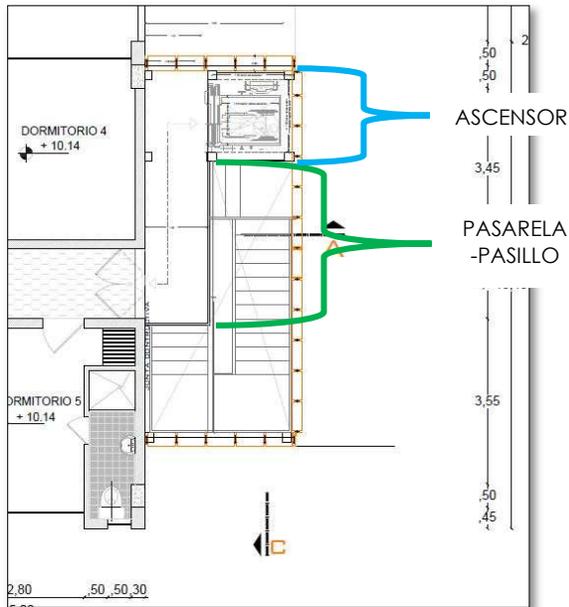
Propuesta, tercer piso de nuevo hall.
